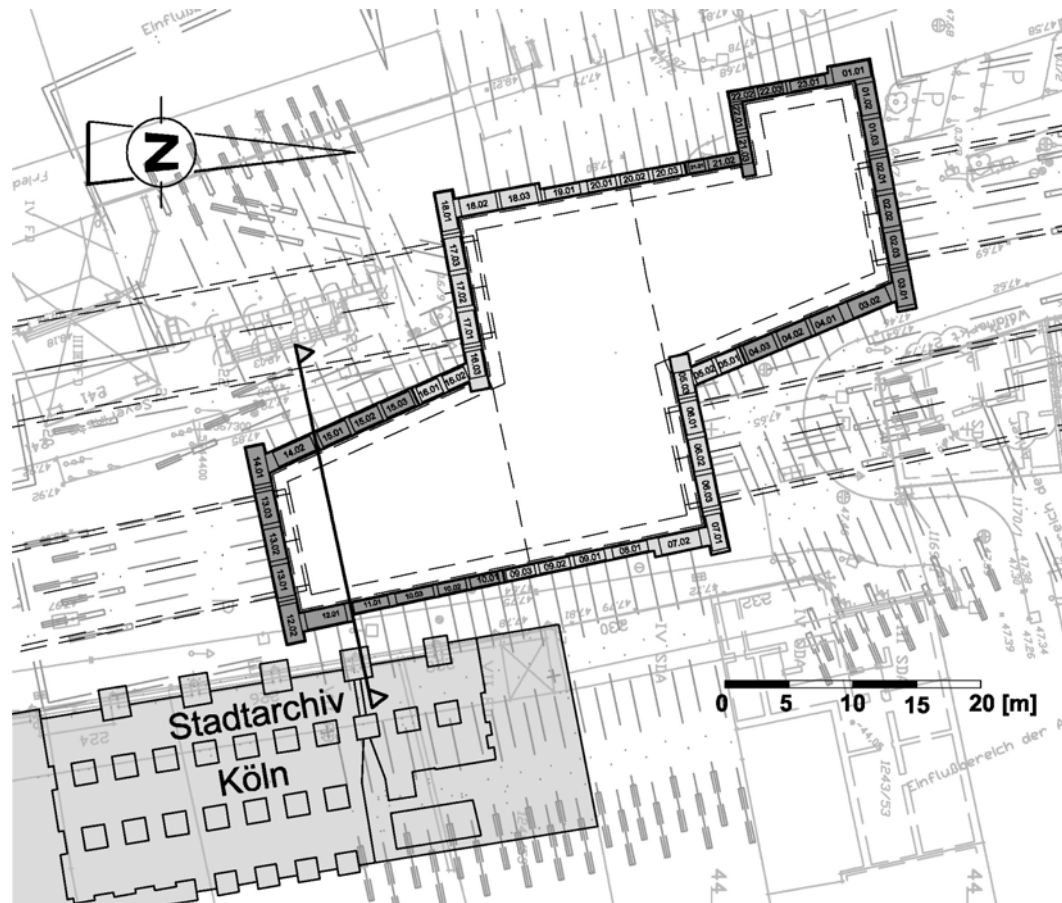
Grundriss der Baugrube Waidmarkt mit Stadtarchiv Köln
